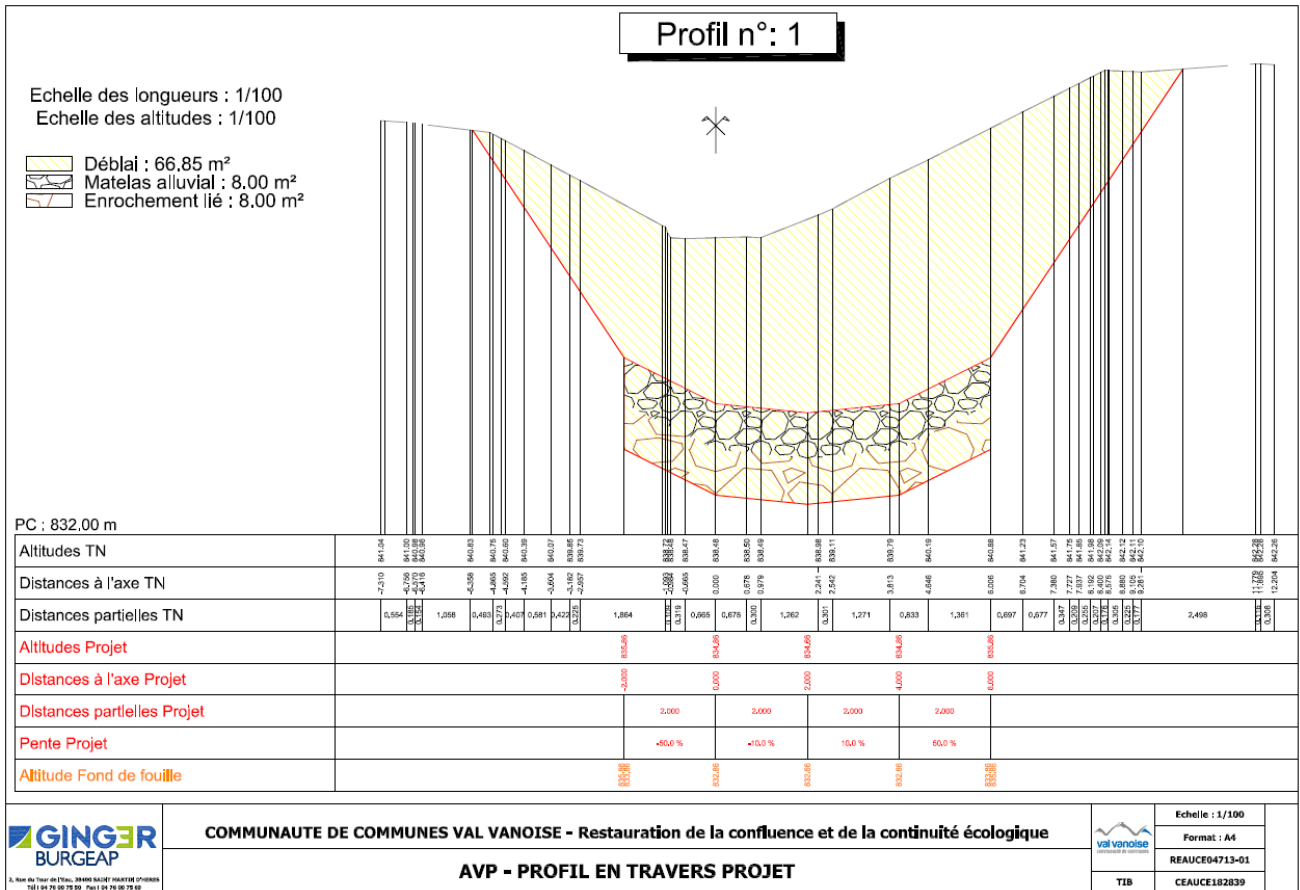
Profil en travers n°1 AVP – largeur en base de 8 m, matelas alluvial en enrochement libre pavé et compacté sur une épaisseur de 1 m (source : BURGEAP Autocad, « sans échelle »).
